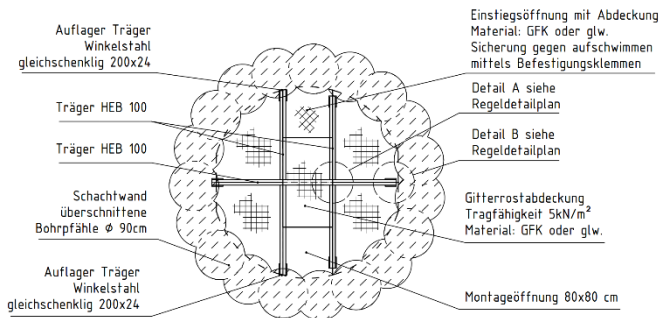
Draufsicht und Ansicht Zwischenbühne
